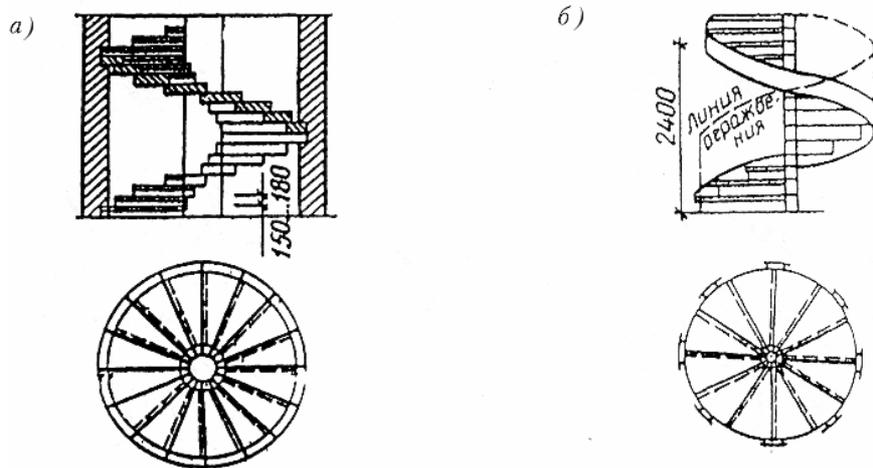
Схемы устройства винтовых лестниц с несущими элементами внешнего периметра: а – с опиранием на стены; б – с опиранием на деревянную тетиву
